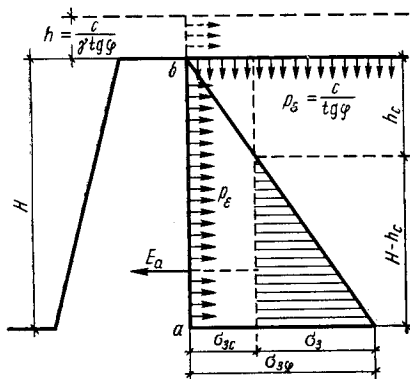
Определение давления связных грунтов на подпорную стенку
